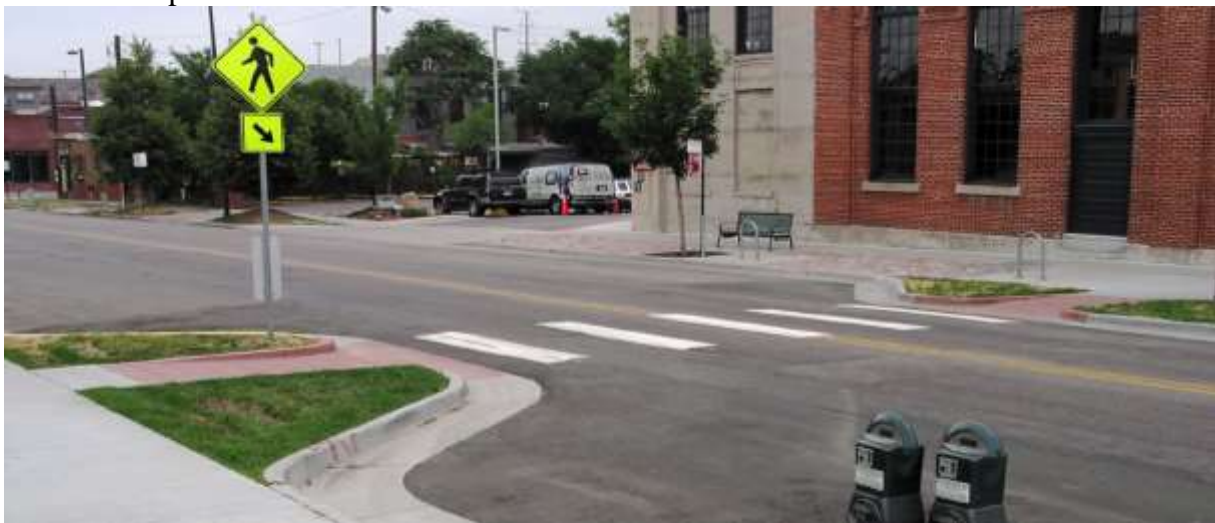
D - Trecere de pietoni cu distanta redusa, insula de odihna (cand este cazul) si ridicarea suprafetei de traversare la nivelul trotuarului pentru siguranta pietonilor.
